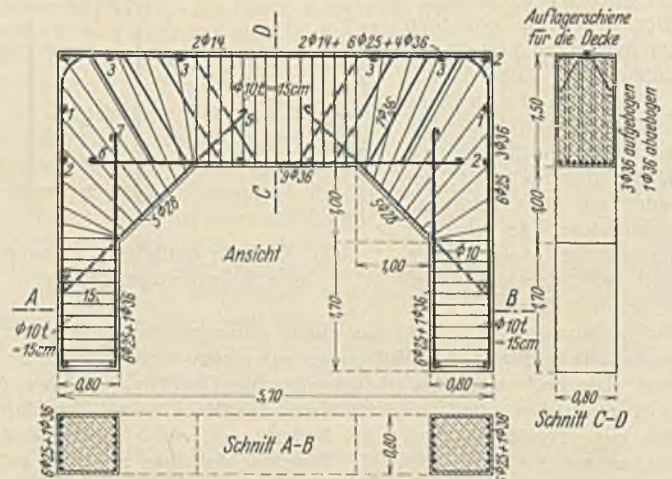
Bewehrung eines Eisenbetonrahmens.
